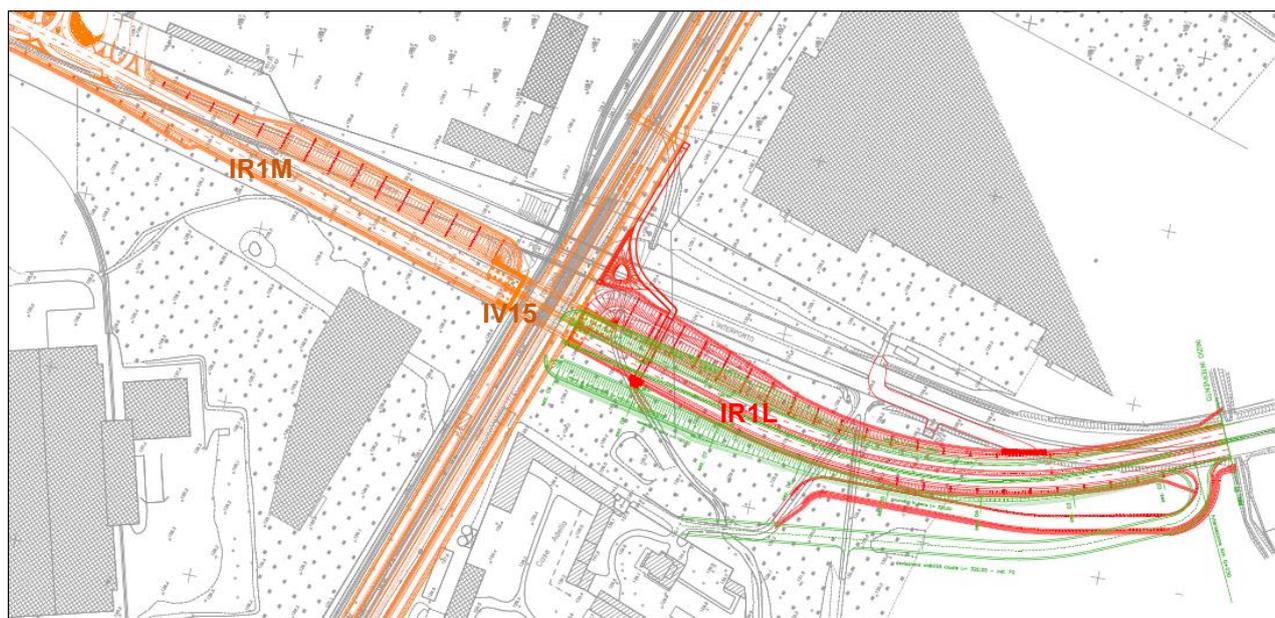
Localizzazione della rampa di approccio IR1L nel progetto approvato (in colore verde) ed in variante (colore rosso)
